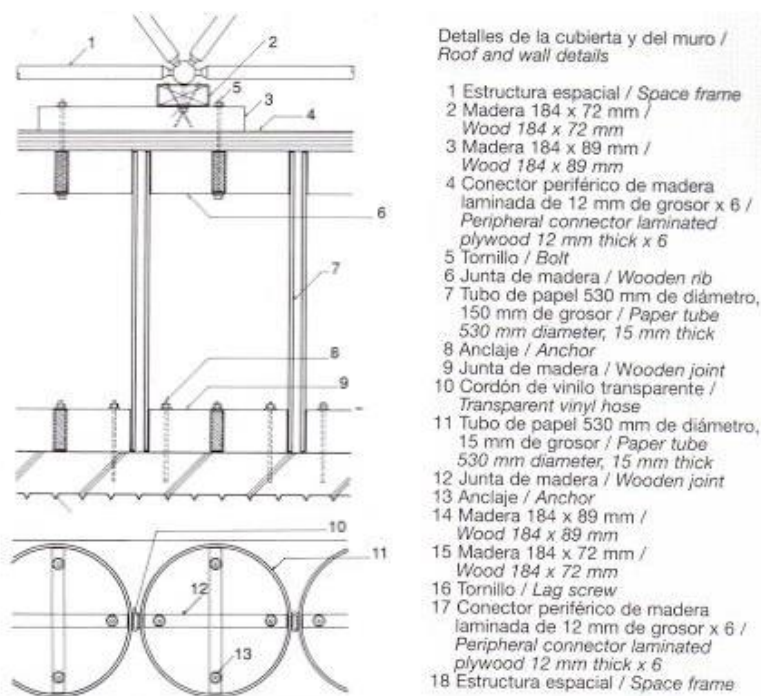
Detalle constructivo de tubos utilizados en el pabellón de Odawara (Arquitecto de guardia, n.d.).
